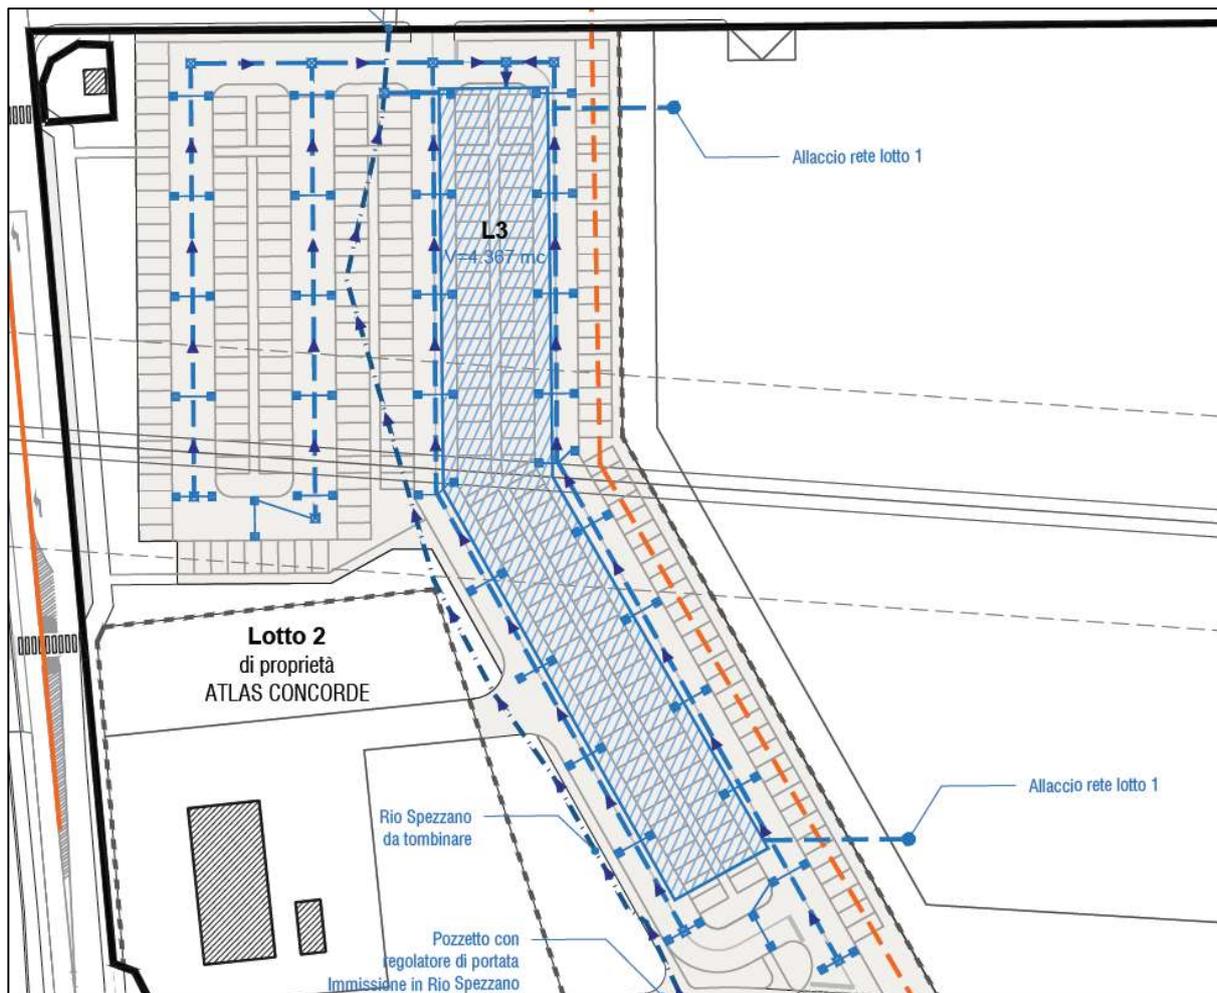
Planimetria di progetto della vasca di laminazione a servizio del comparto Atlas prevista sotto al parcheggio pubblico Atlas.
